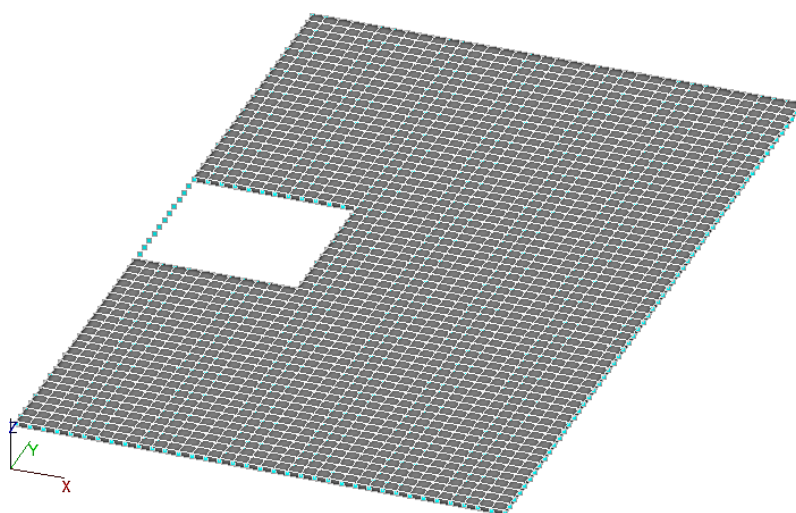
Розрахункова схема монолітного безбалкового перекриття
